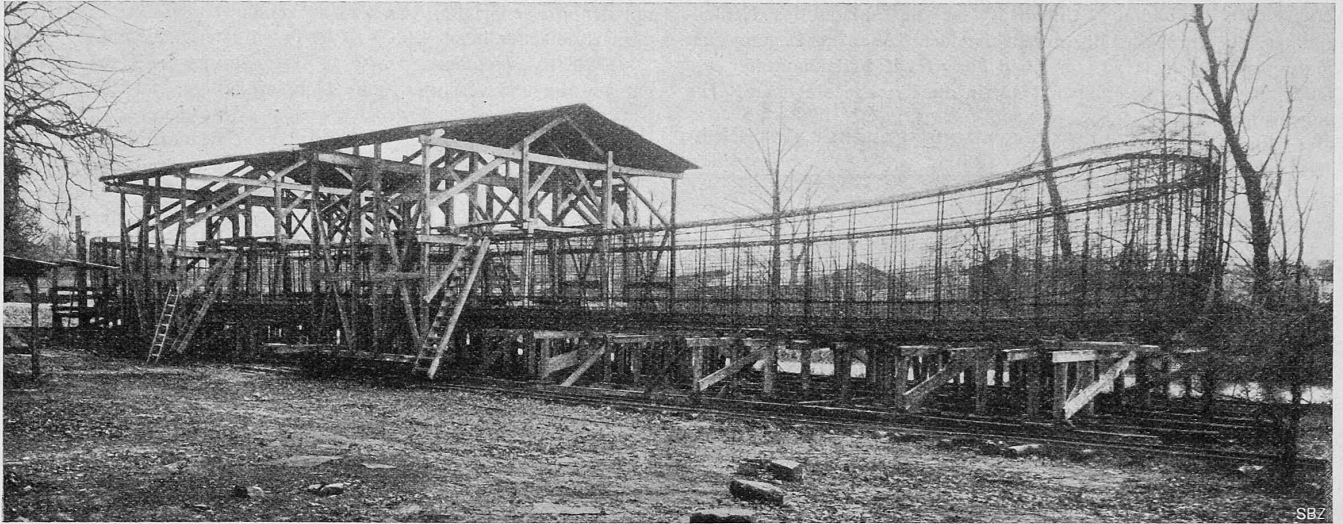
Armierung und Betonierungsgerüst des Eisenbeton-Schleppkahns nach „System Züblin-Koller“, ausgeführt von Ed. Züblin & Cie., Strassburg.
